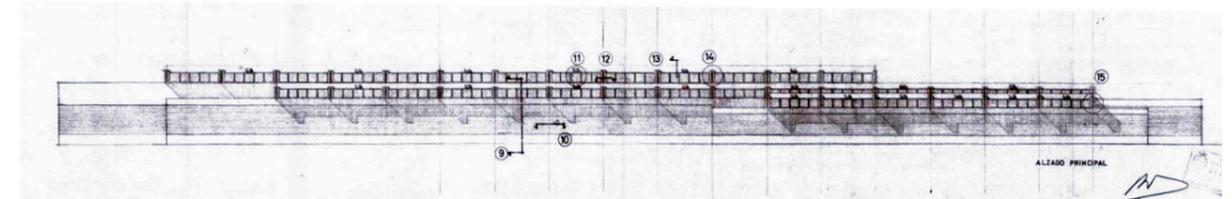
Alzado principal del proyecto construido, escala 1:100
